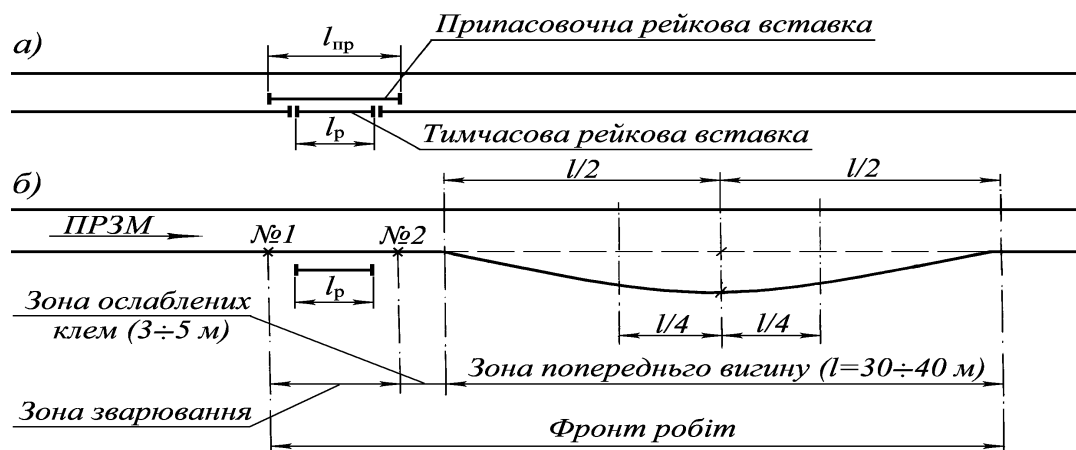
Технологічна схема місця проведення зварювальних робіт способом попереднього вигину рейкової пліті:
